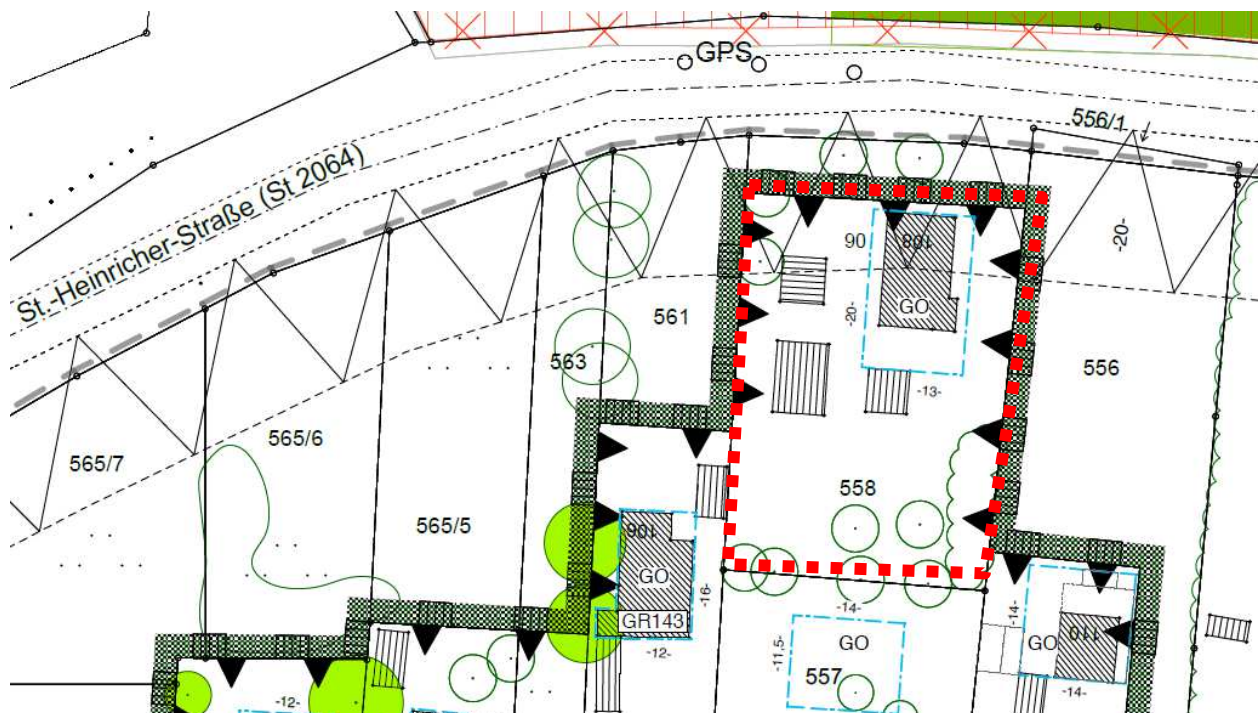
Lage des Auszug Planzeichnung BPÄ Seeshaupt Süd I- Teilbereich Schechener Str. Geltungsbe-
